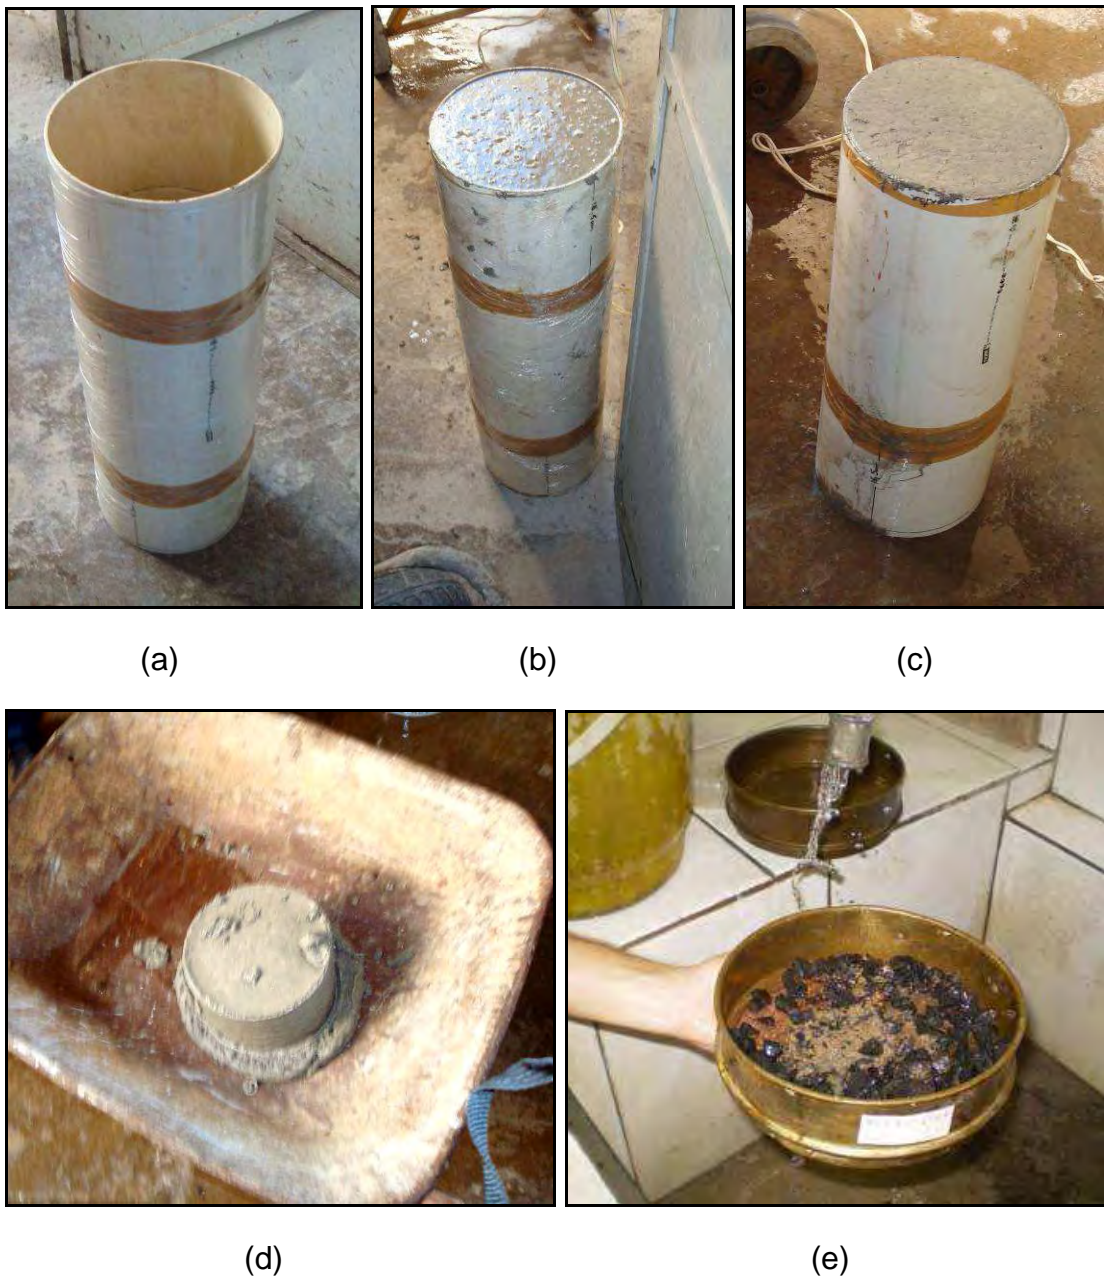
(a) Aparato com as seções unidas com fita adesiva, (b) Concreto em repouso, (c) Topo retirado (d) Concreto retirado da seção e (e) Amostra de concreto sendo lavada na peneira de 5 mm.
